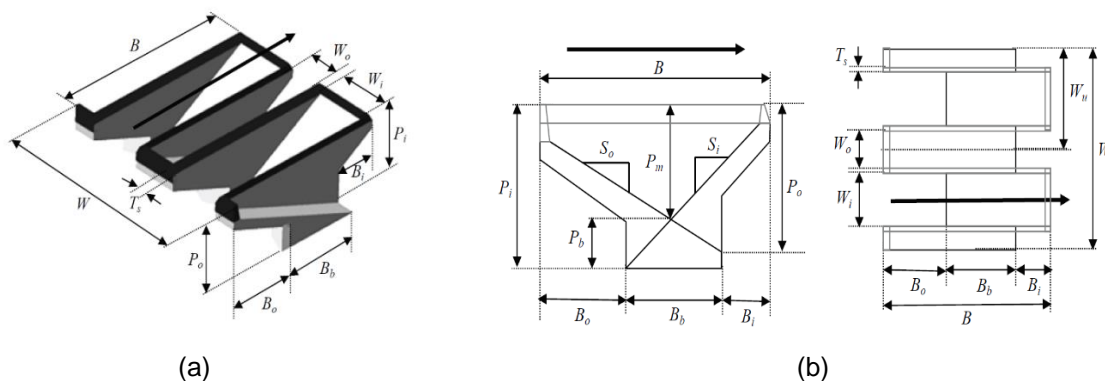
Principais grandezas de uma soleira descarregadora em teclado de piano: a) vista 3D; b) perfil e planta (adaptado de Pralong *et al.*, 2011).
